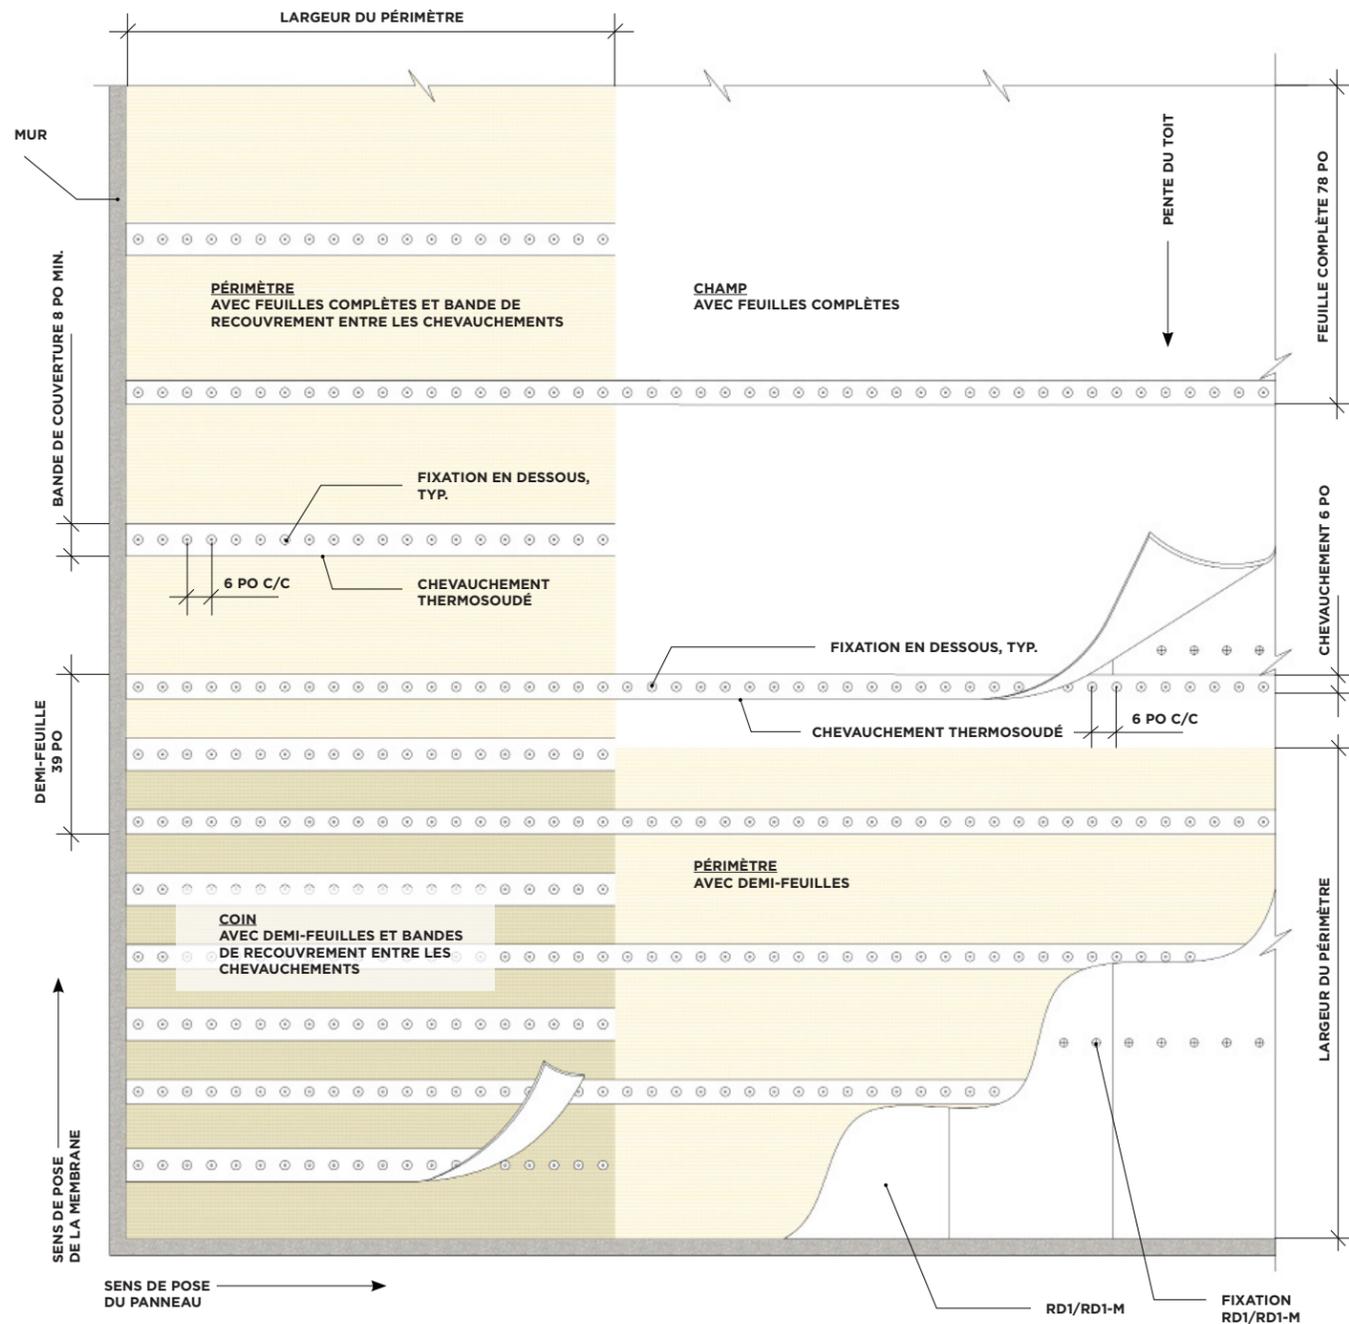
MEMBRANE TPO/PVC FIXEE MECANIQUEMENT ONEDEK (EN UTILISANT DES DEMI-FEUILLES DE PERIMETRE) (VUE EN PLAN)
